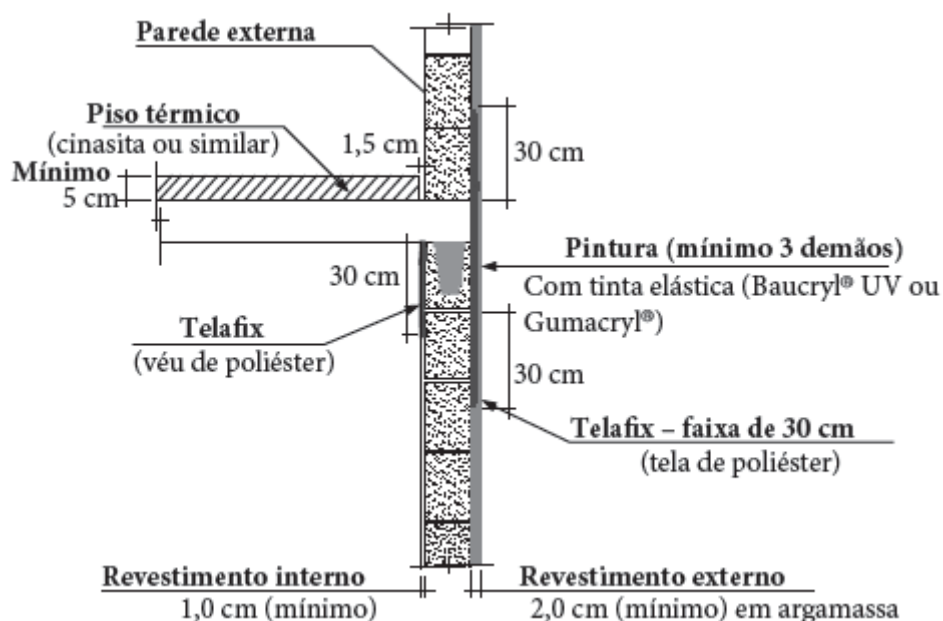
Exemplo de Proteção Térmica sobre a laje de Cobertura
